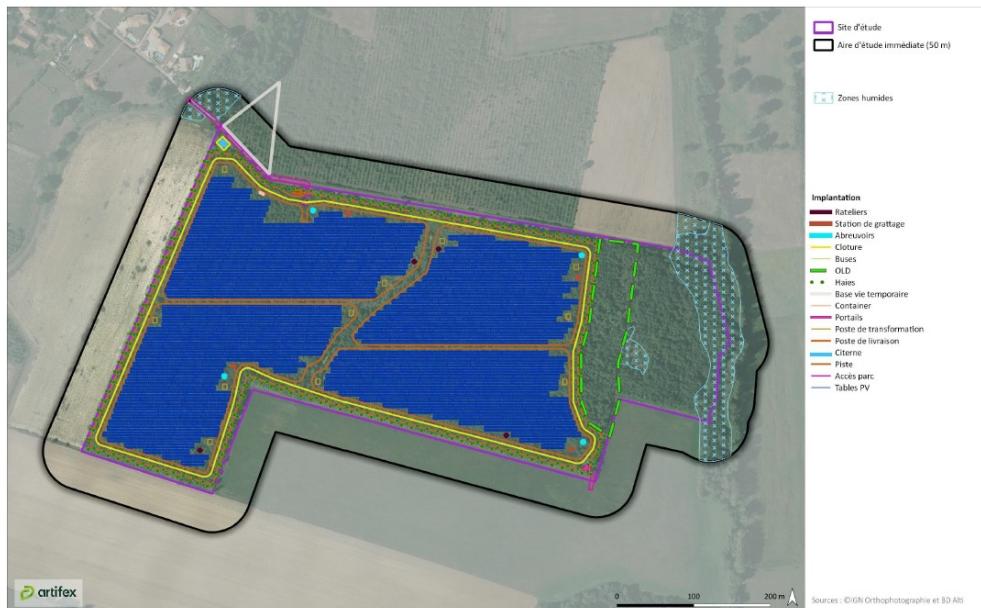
Plan de masse final de la centrale de Montaut Noisetiers Energies
